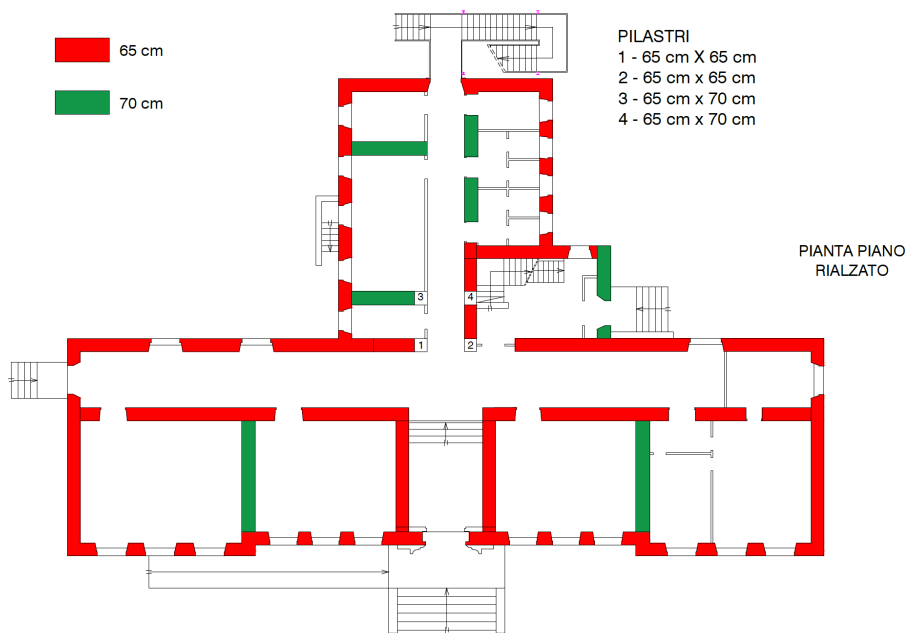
Pianta struttura benchmark n.5– Piano rialzato
